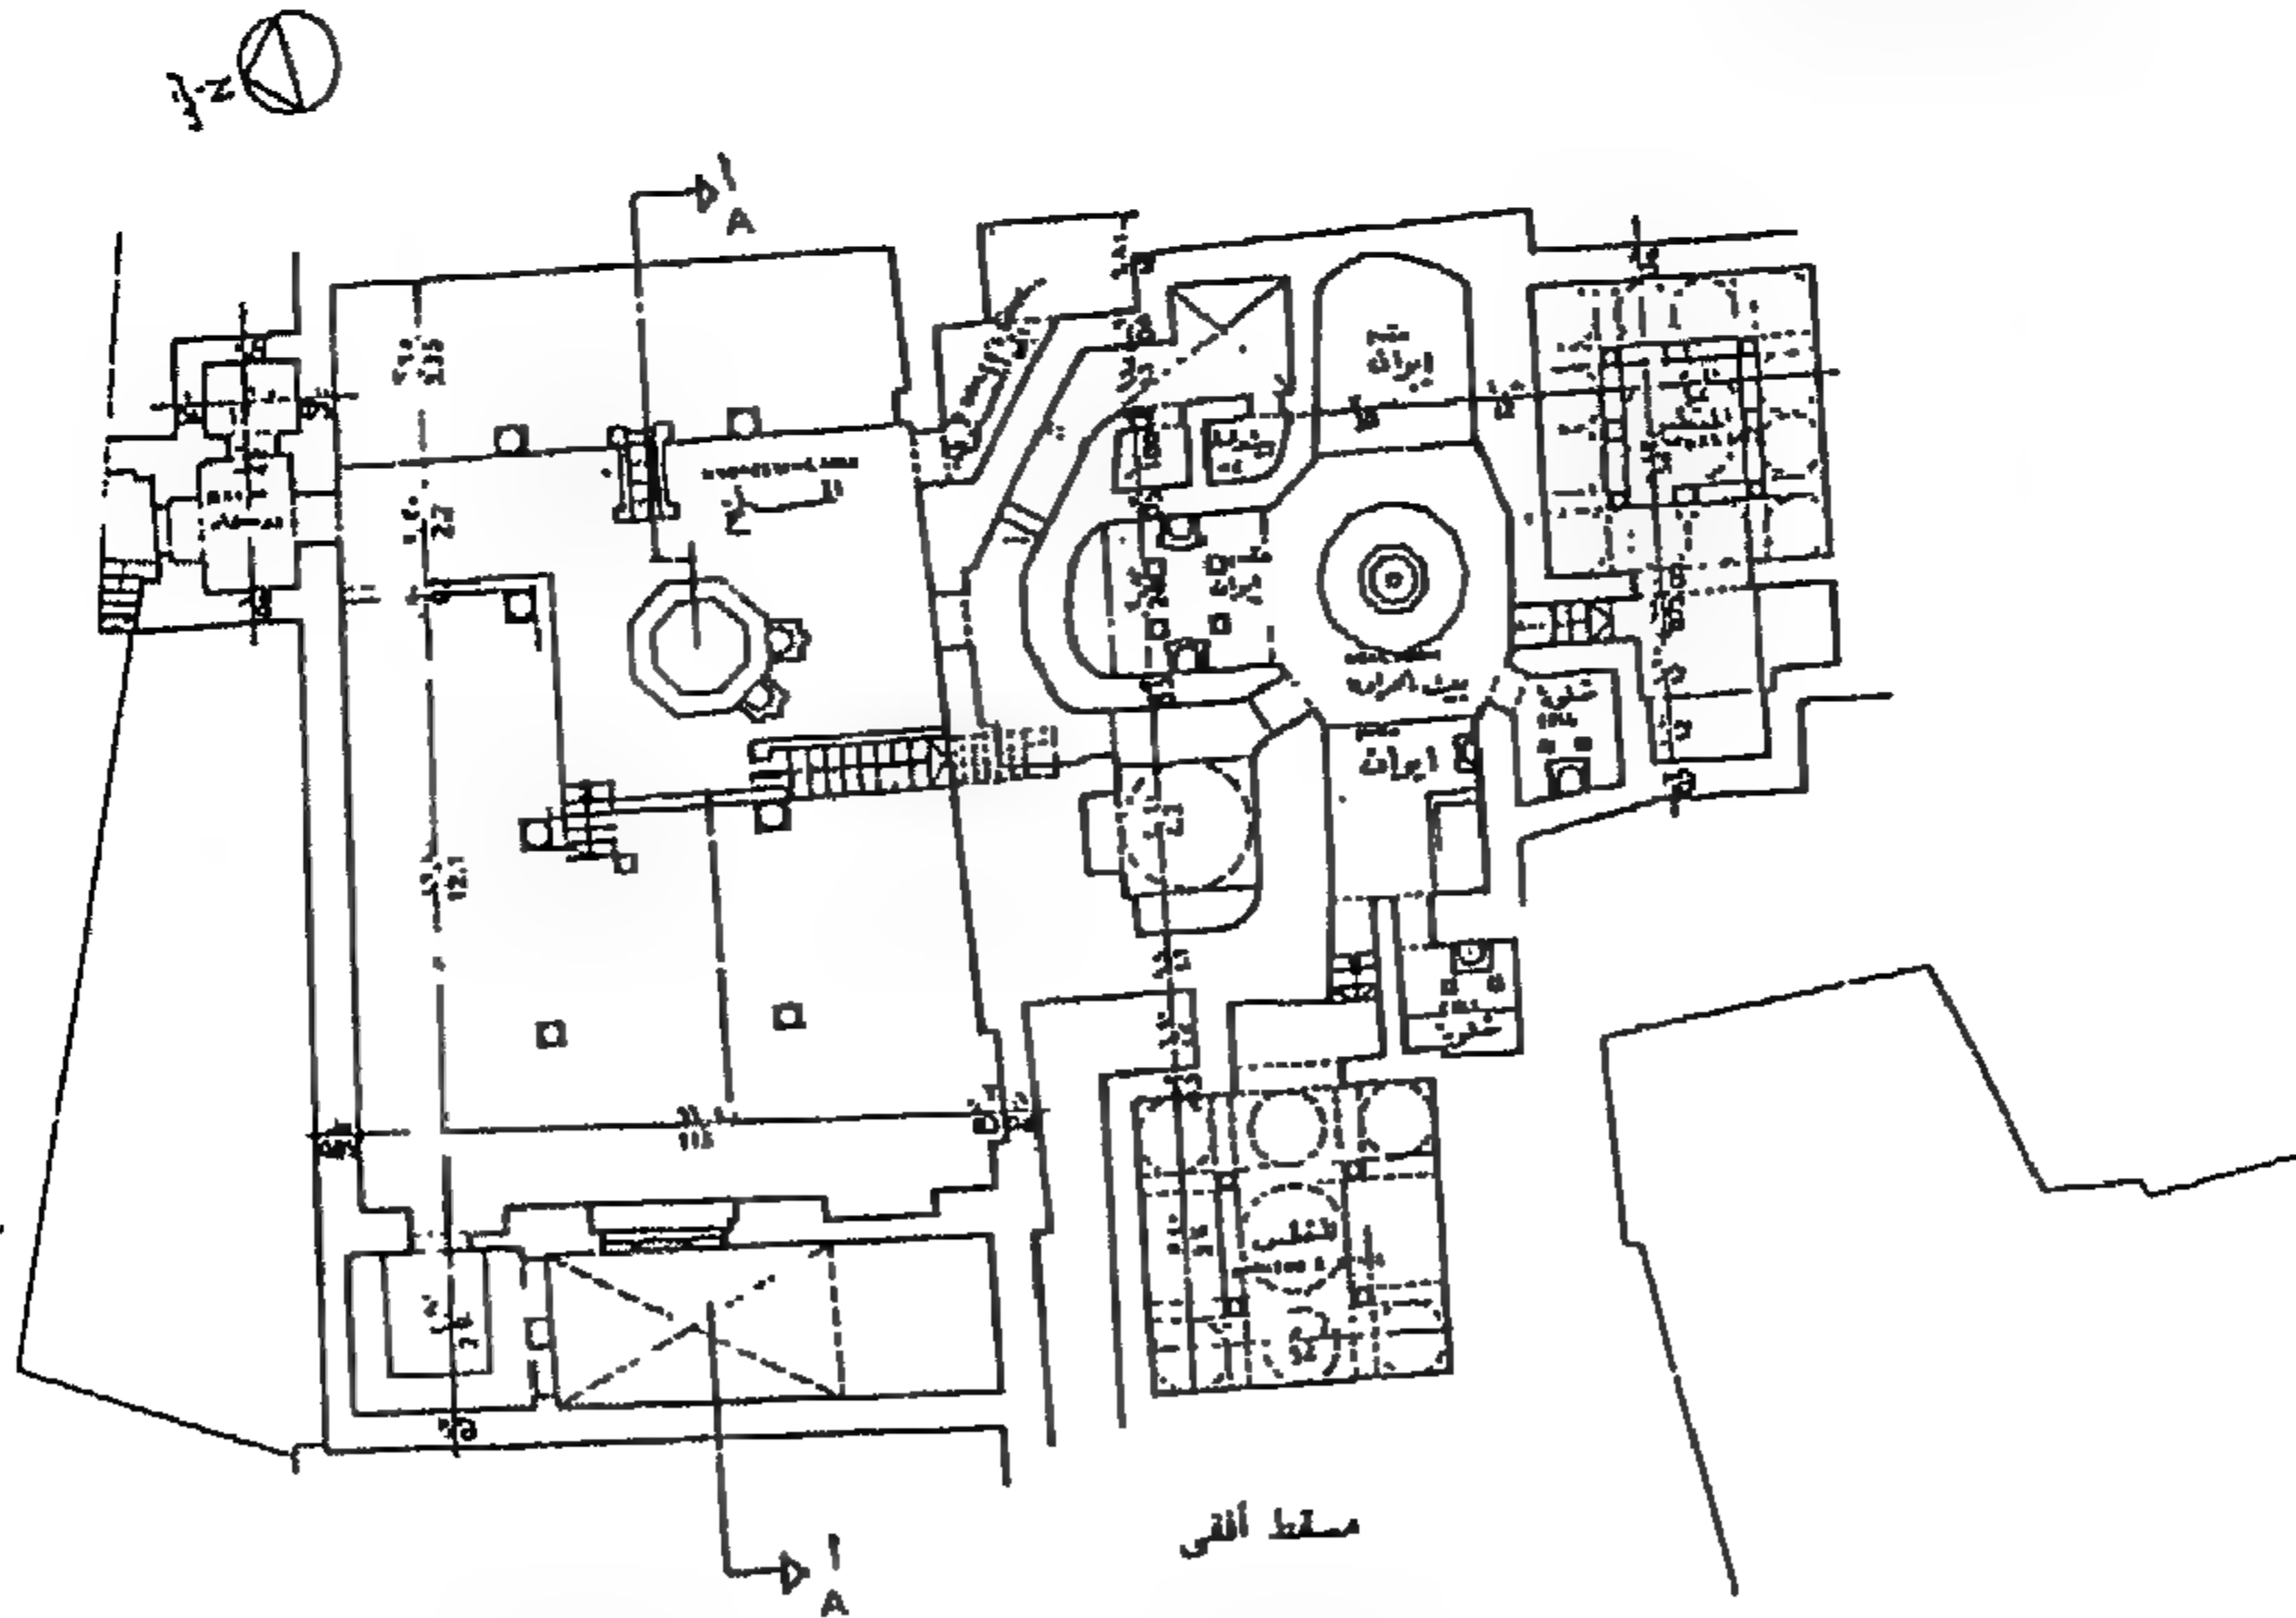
مسقط أفقي لحمام يشتاك بالقاهرة. (عن المجلس الأعلى للآثار) .
